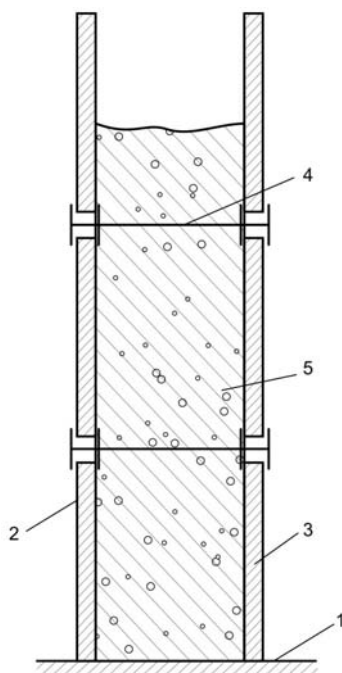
Опалубка из древесно-минеральных материалов: 1 — технологический горизонт; 2 и 3 — внешние и внутренние отдельные щиты опалубки из древесно-минеральных материалов; 4 — гибкие связи; 5 — бетонная смесь
